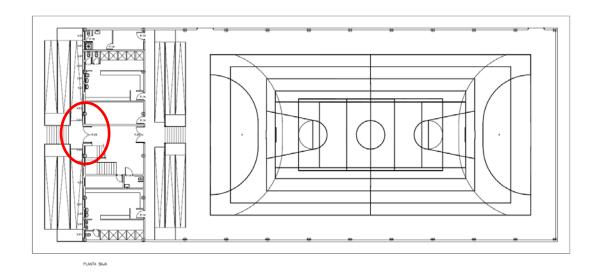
Entrada al pabellón deportivo: alzado y planta del mismo
